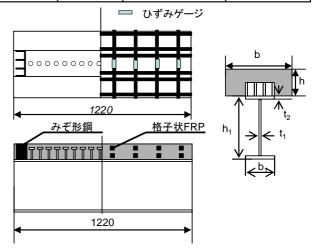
鋼合成桁供試体の形状寸法と断面寸法(mm)
